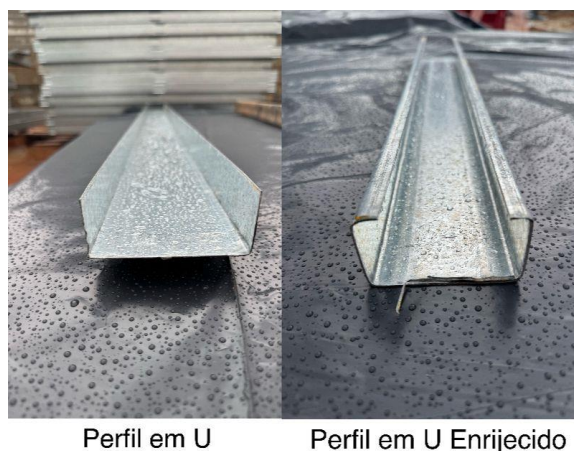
Tipos de perfis metálicos para LSF (Fonte: Próprio autor).
